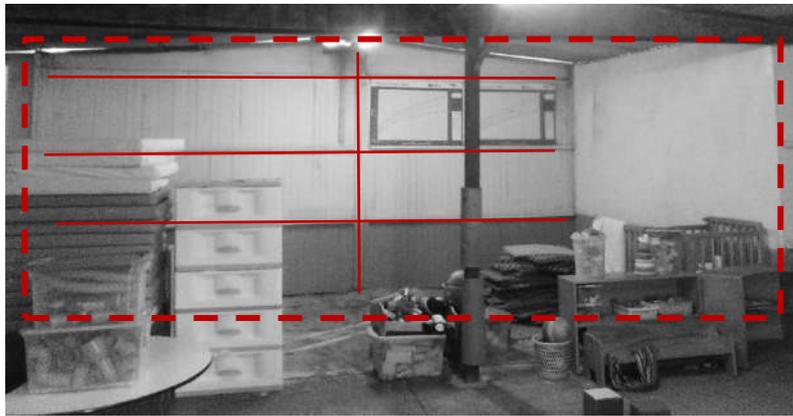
Módulo 01 – Paneles prefabricados de madera en el interior.
